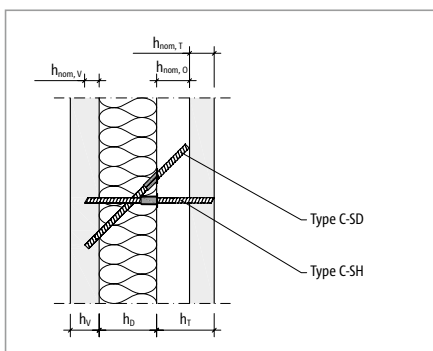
Schöck Isolink® type C-SH, C-SD: données de la section du mur préfabriqué;  $h_{nom,V} < h_V$
